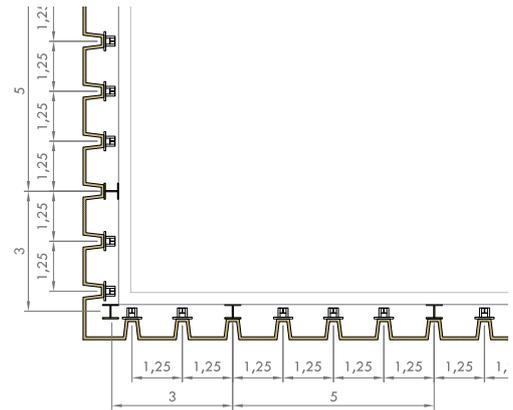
Detalle constructivo paneles prefabricados de hormigón de la primera planta. Elaboración propia.
